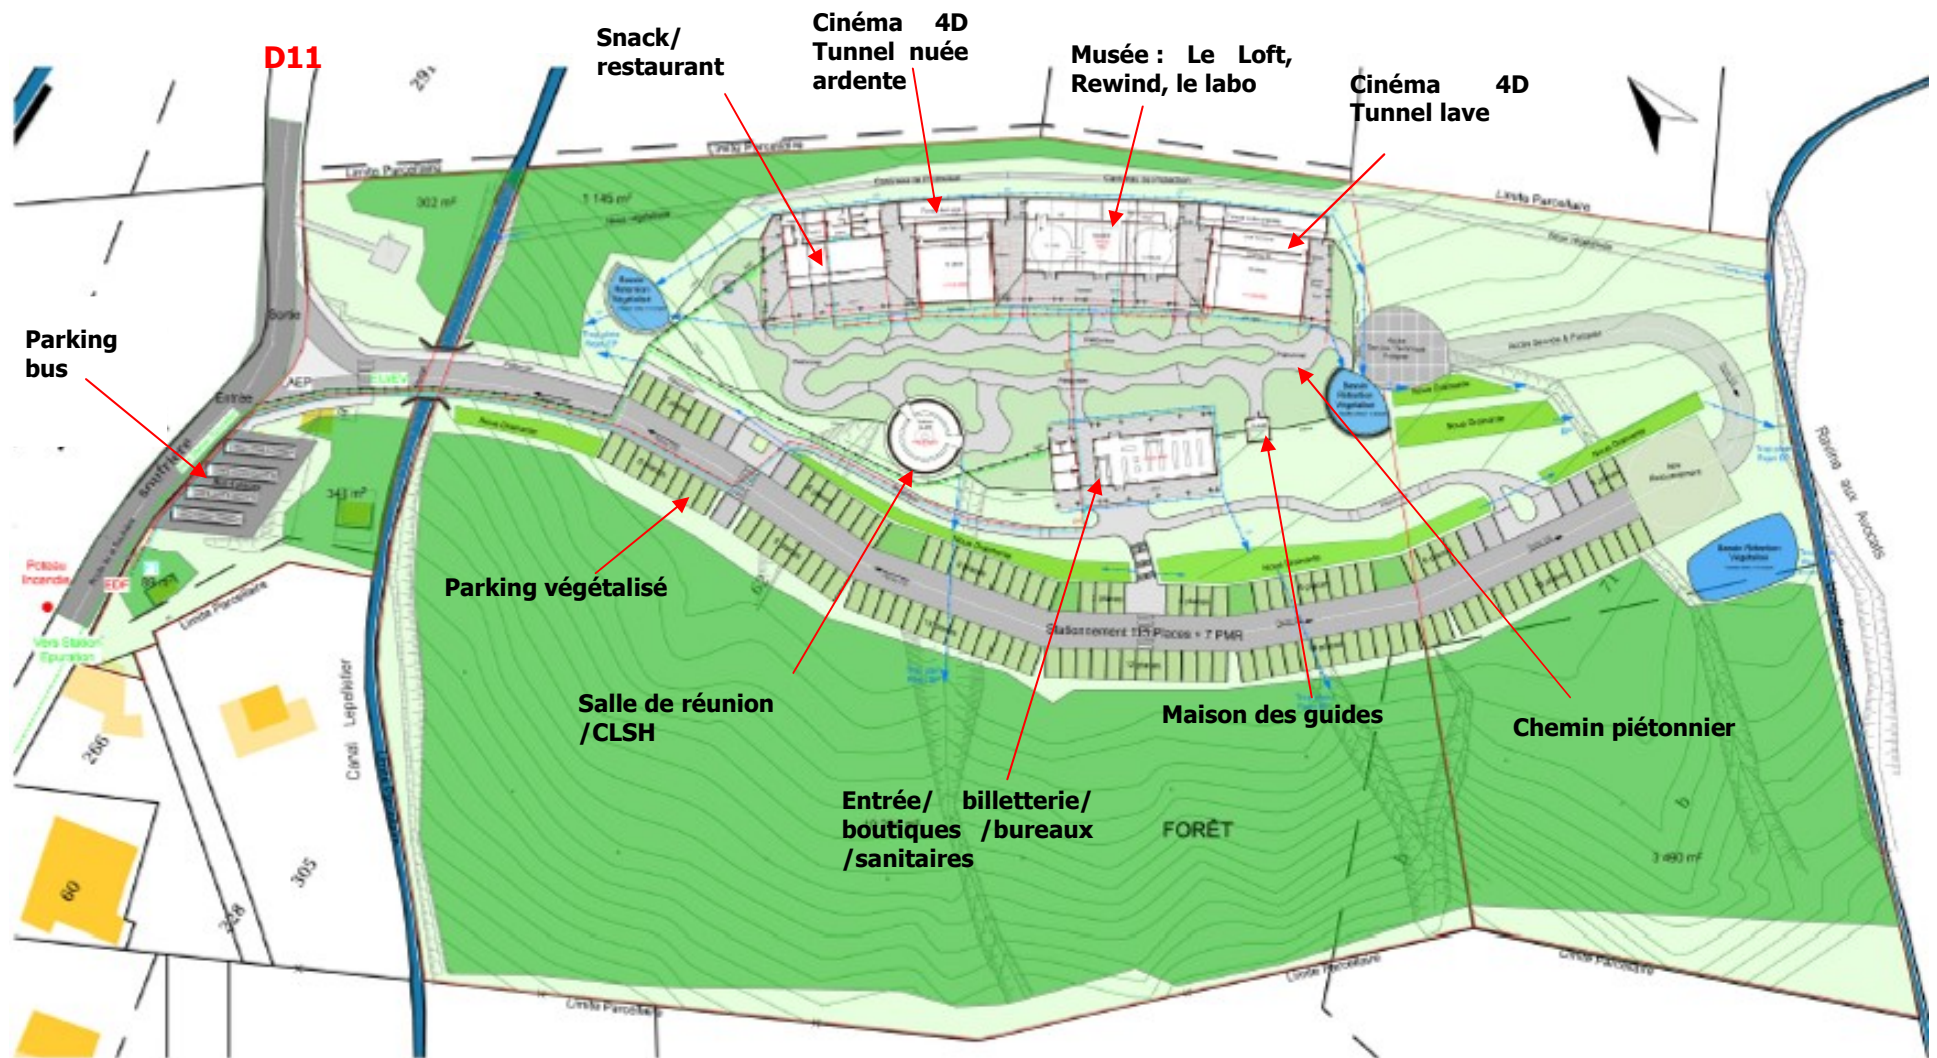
organisation du complexe touristique de Beausoleil (source : Plan Masse, SELARL d'Architecture Olivier Gros-Dubois)
